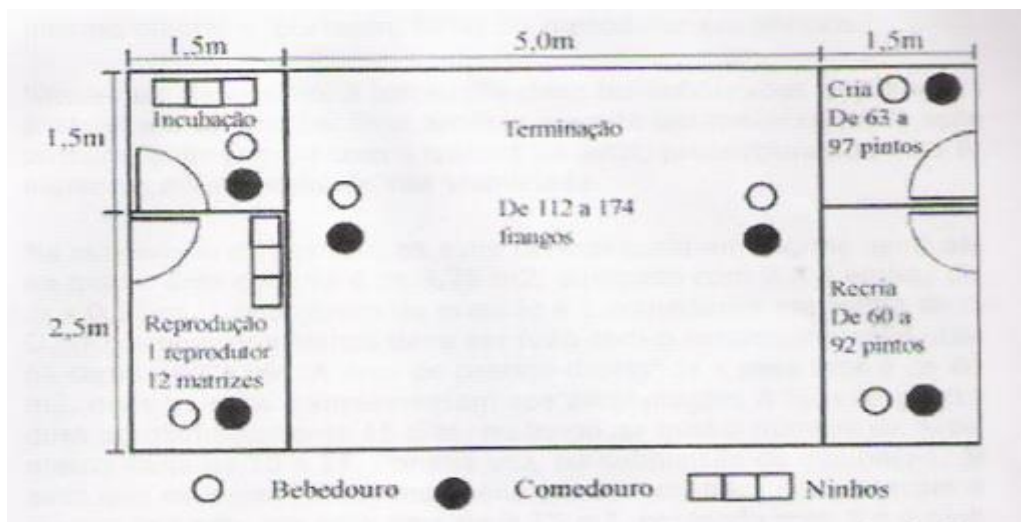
Planta baixa das instalações para o sistema alternativo de criação de frangos caipiras para corte. Fonte: Embrapa, 2005.
